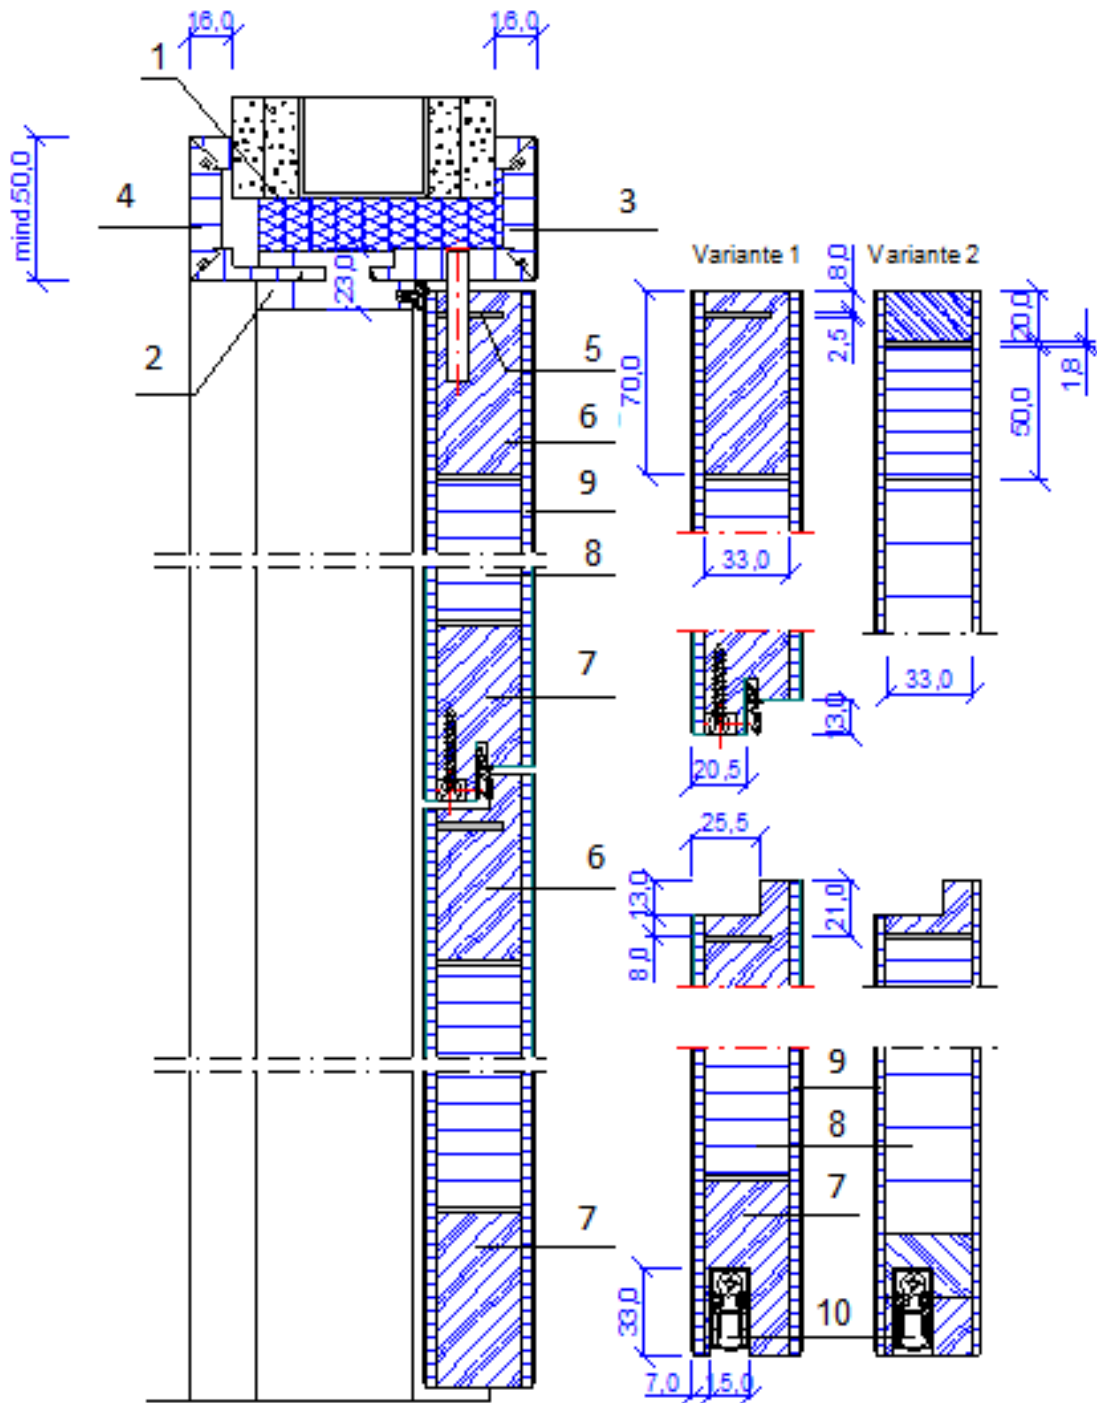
Verticale doorsnede – zonder bovenpaneel - Type B
